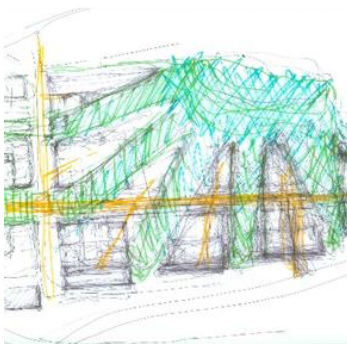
Eva Jiřičná – skica detailu spojení – Oranžerie / Somerset House
